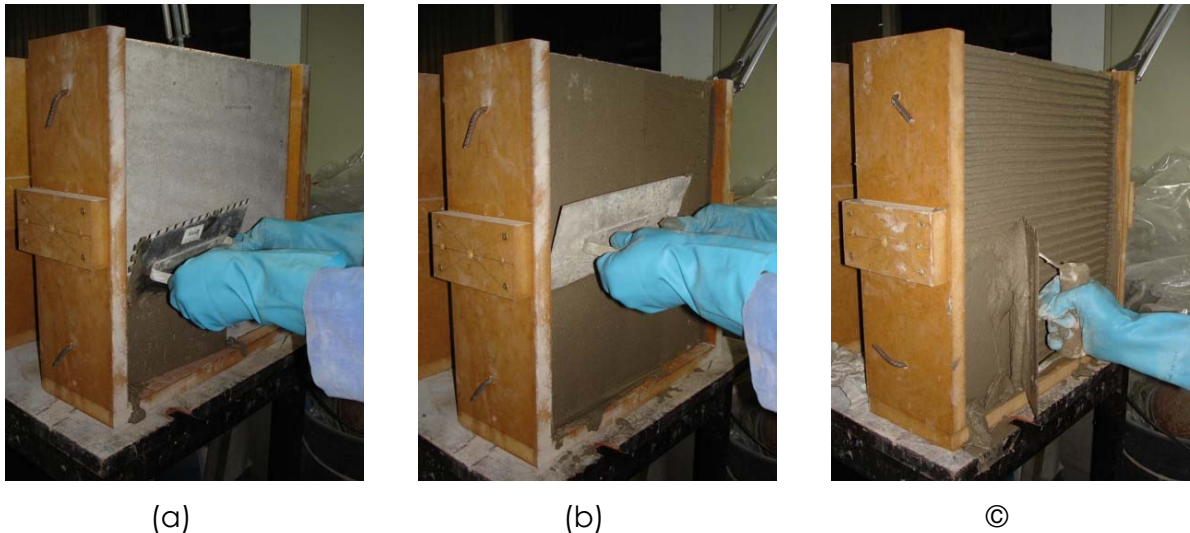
aplicação da argamassa de chapisco: (a) imprimação, (b) aplicação da camada espessa e (c) execução das ranhuras
